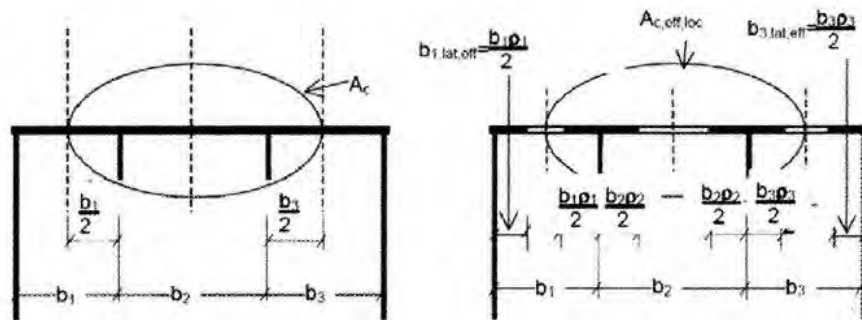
Lastra irrigidita uniformemente compressa
